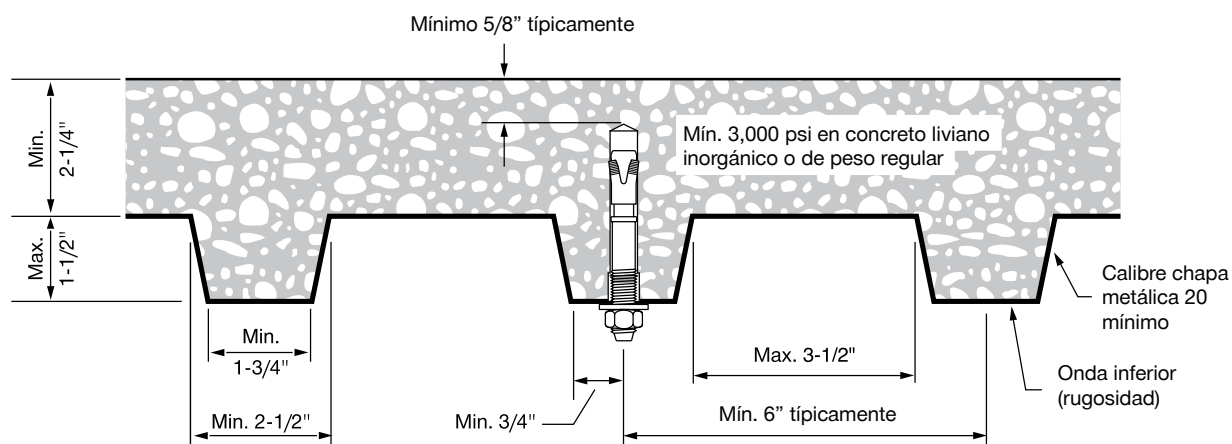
Instalación de Kwik Bolt TZ en el plafón de concreto sobre el piso de la chapa metálica y la estructura del techo – Chapa B
